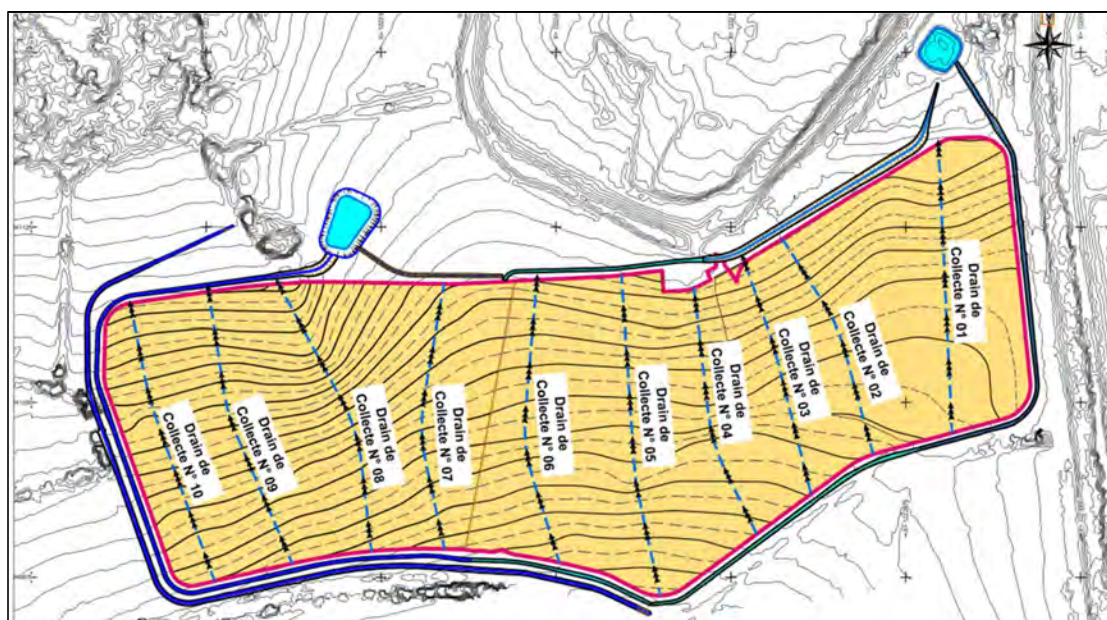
Implantation des drains de collecte des eaux d'infiltration
